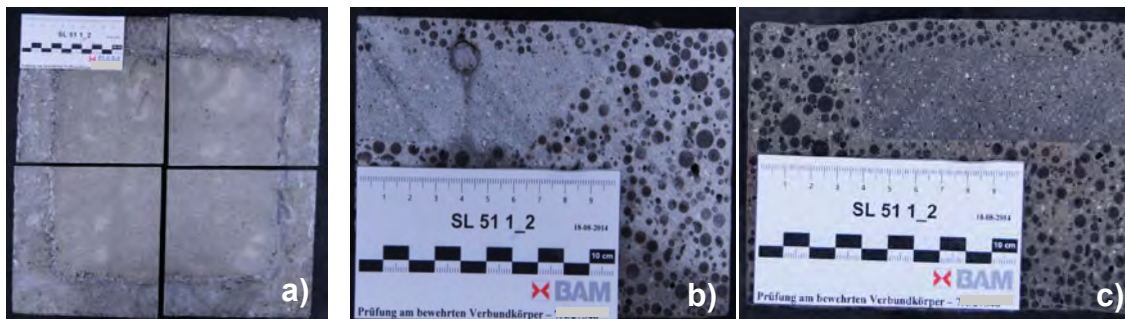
a) aufgeschnittener Verbundkörper; b) Bewehrungsstab; c) unbewehrter Bereich
